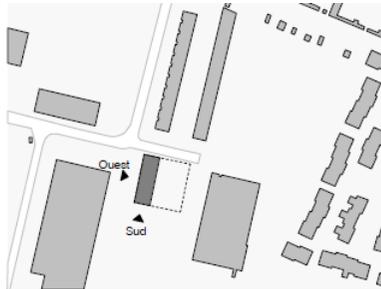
Plan des façades sur la zone chaufferie (2/4)
